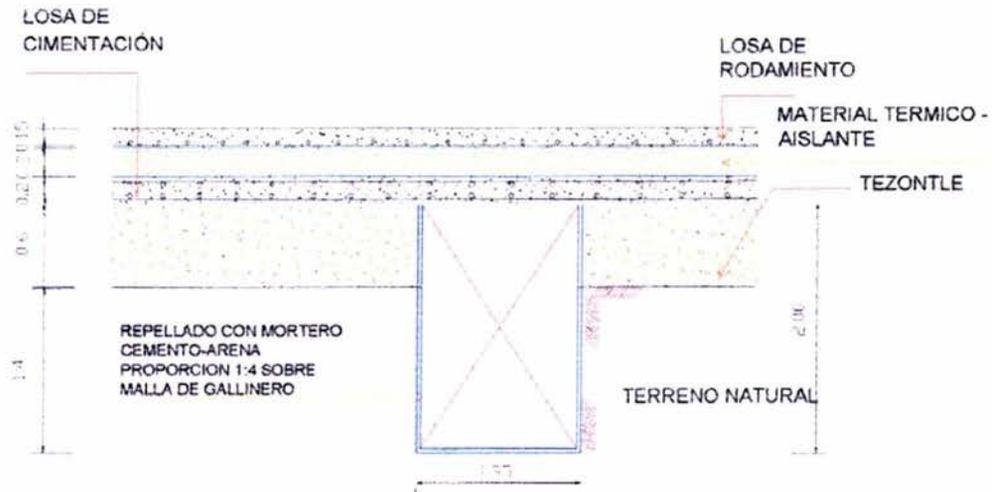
Demolición de losa de cimentación y excavación en terreno natural
